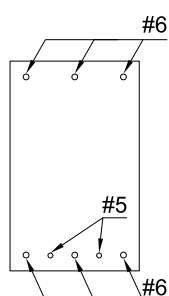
Secciones de vigas que muestran los aceros longitudinales 9-17
